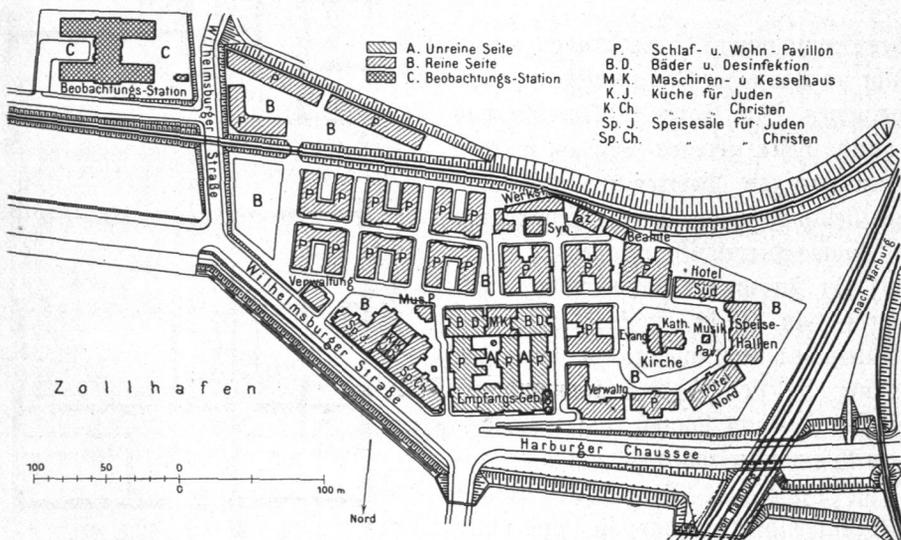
Die Auswandererhallen der Hamburg-Amerika Linie, Lageplan.
